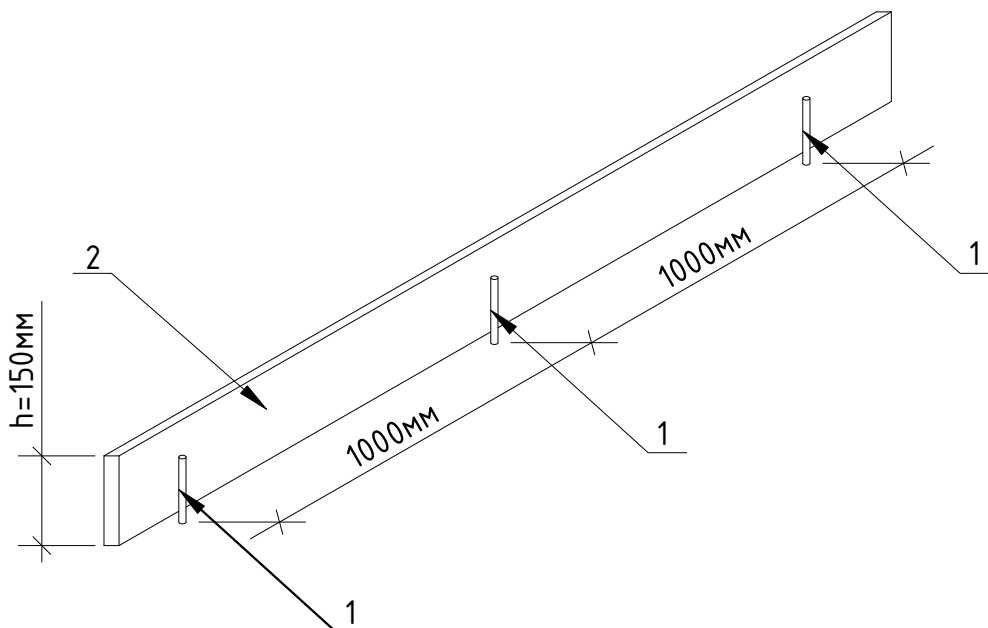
Установка опалубки бетонной подготовки. 1 – арматурный стержень. 2 – доска, $t=50\text{мм}$.
